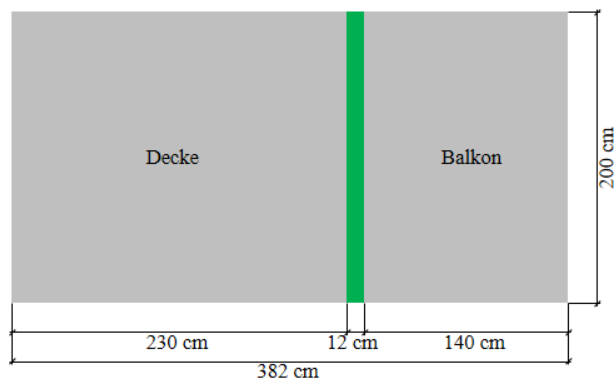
Maße des Labor-Prüfaufbaus, grün: Dämmelement.
